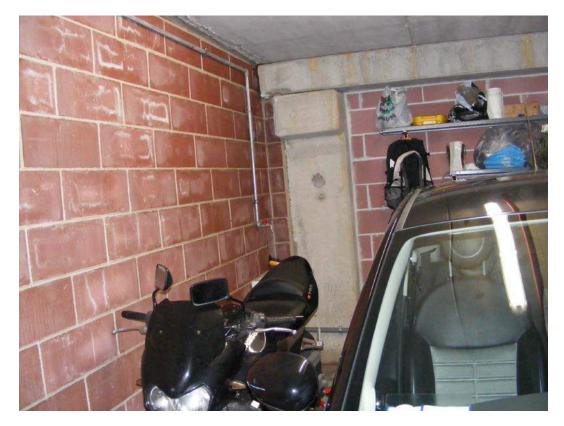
Le infiltrazioni dalla parete adiacente la palificata
